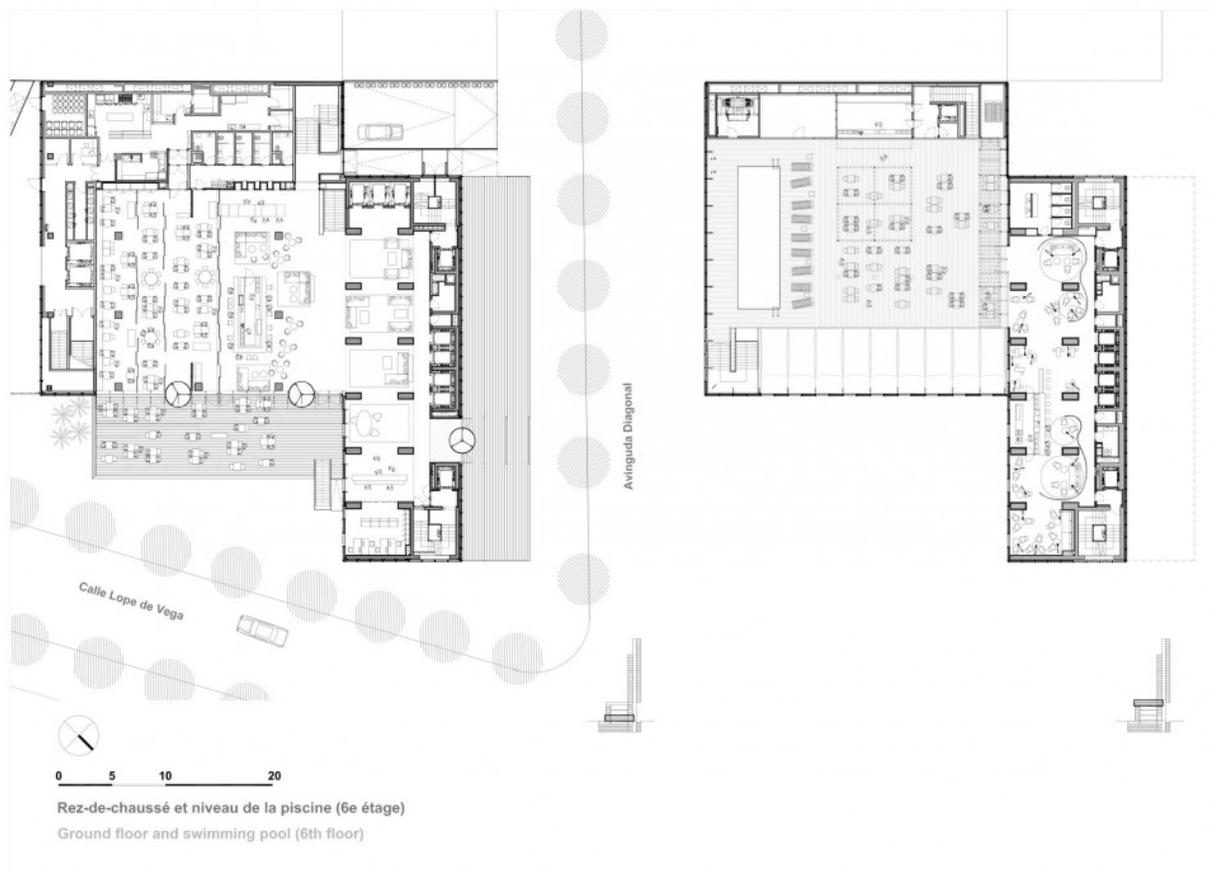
HOTEL ME BARCELONA – PLANTAS ESTAR/RESTAURANTE E PISCINA – 6º PAVTO
